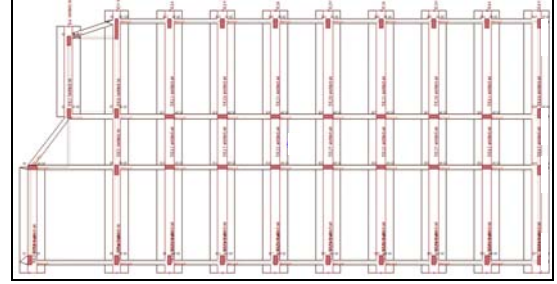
Kütahya, Emet İÖO binasında kolon kesit daraltması, (Kaplan ve ark., 2006b).
